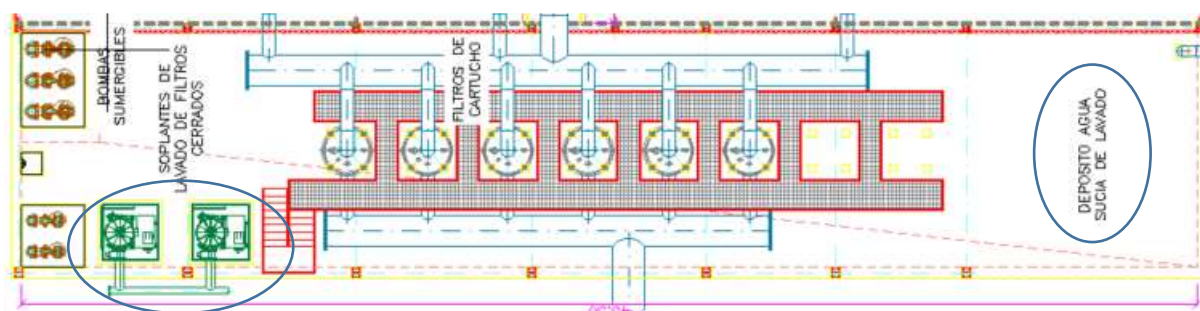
Plano planta de depósito de agua sucia de lavado de filtros. Instalación soplantes de lavado.
